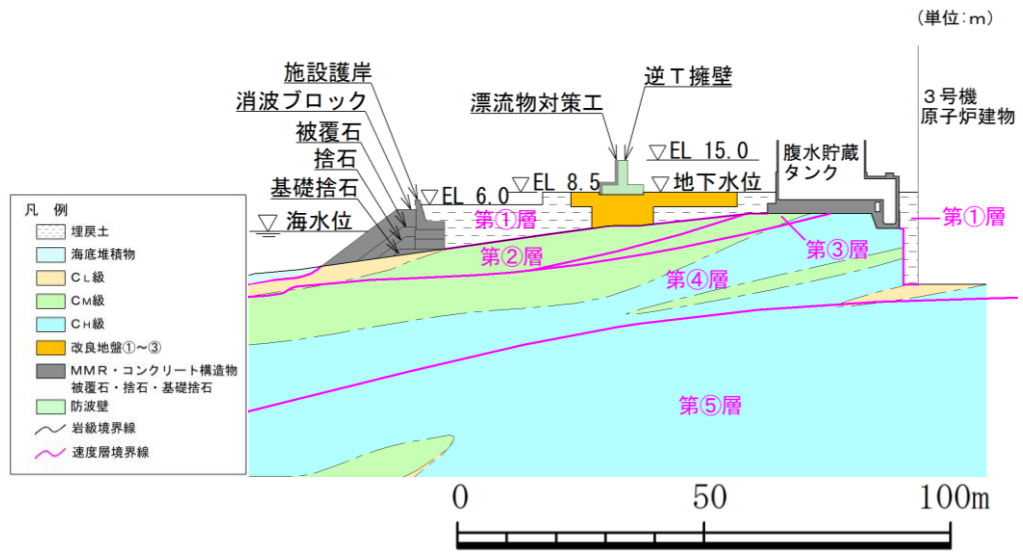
防波壁（逆 T 擁壁）の横断面図（③-③断面）
